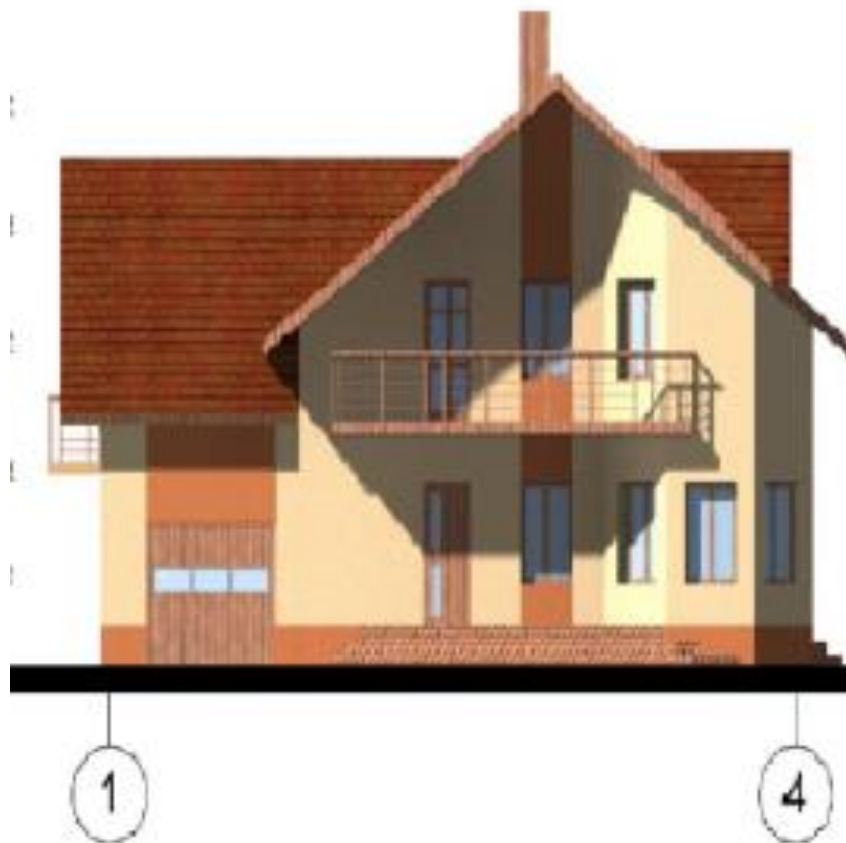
Будинок 2. Індивідуальний 6-и кімнатний двоповерховий мансардний житловий будинок. Фасад в осях 1 – 4 .
